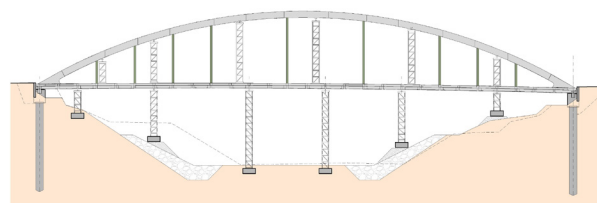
Montaje de la superestructura mediante torres de apeo provisionales
